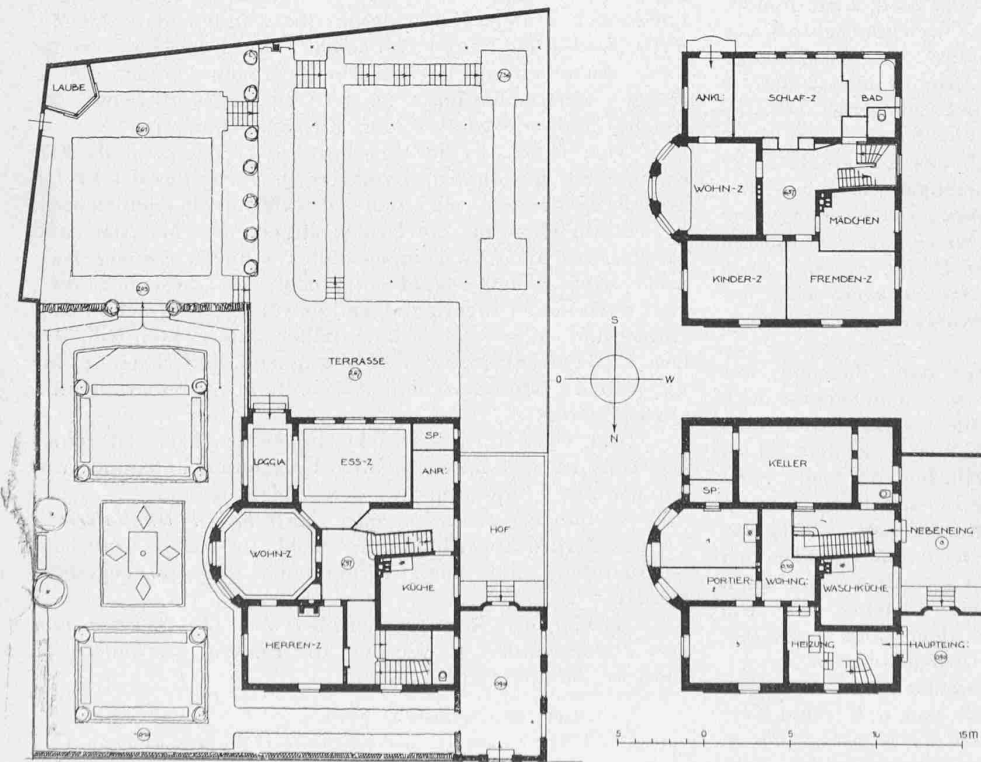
bis 3. Lageplan, Erdgeschoss-Grundriss, Untergeschoss und I. Stock. — 1 : 400. Wohnhaus Steinbock in Frankfurt a/O. von Architekt Hans Bernoulli. (Text auf Seite 91.)
